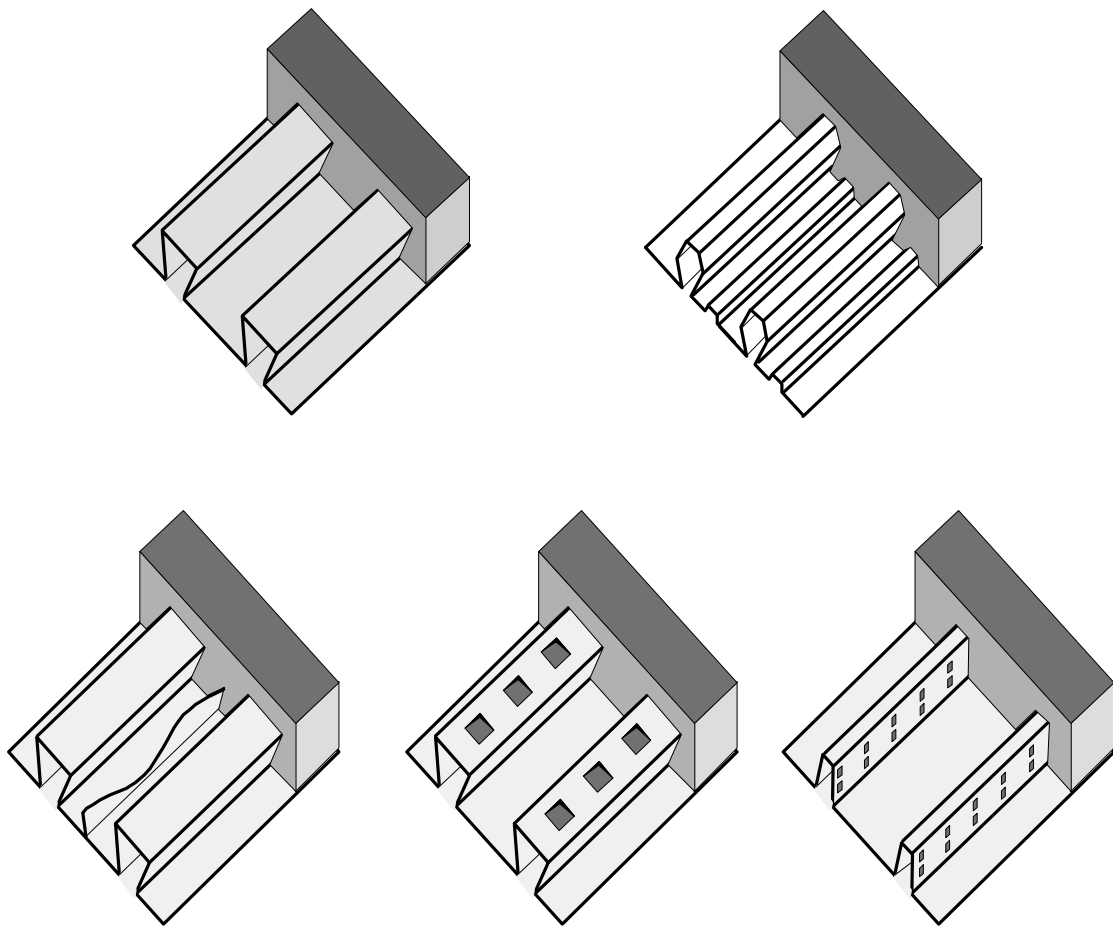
Types de liaisons acier-béton dans les dalles mixtes [13].
